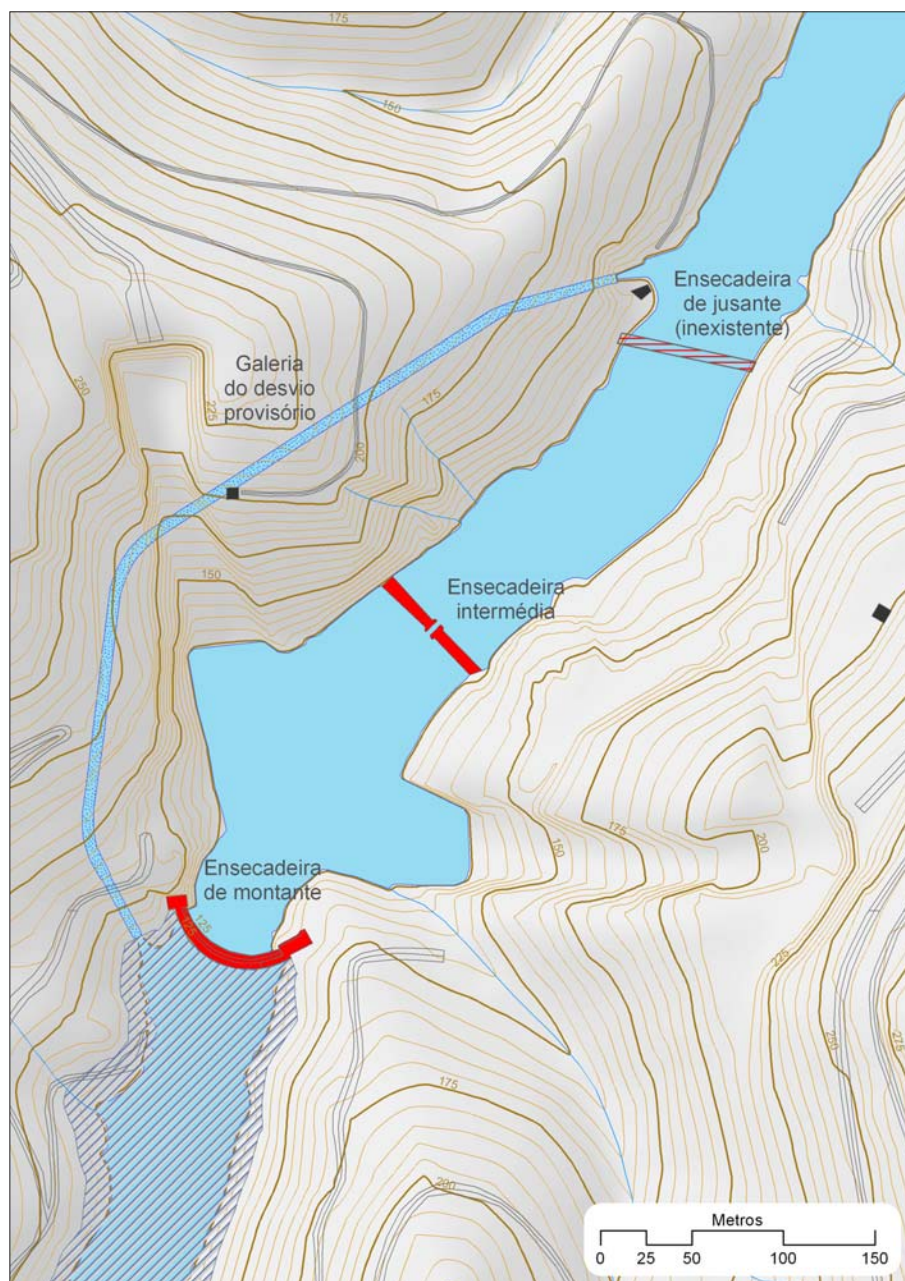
Planta de localização das estruturas de desvio provisório da barragem de Vila Nova de Foz Côa (projeto EDP).
